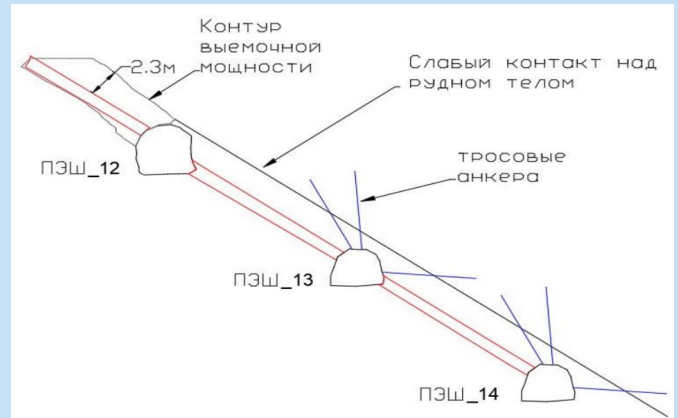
Вид участка для проведения испытаний по тросовому креплению в разрезе.
